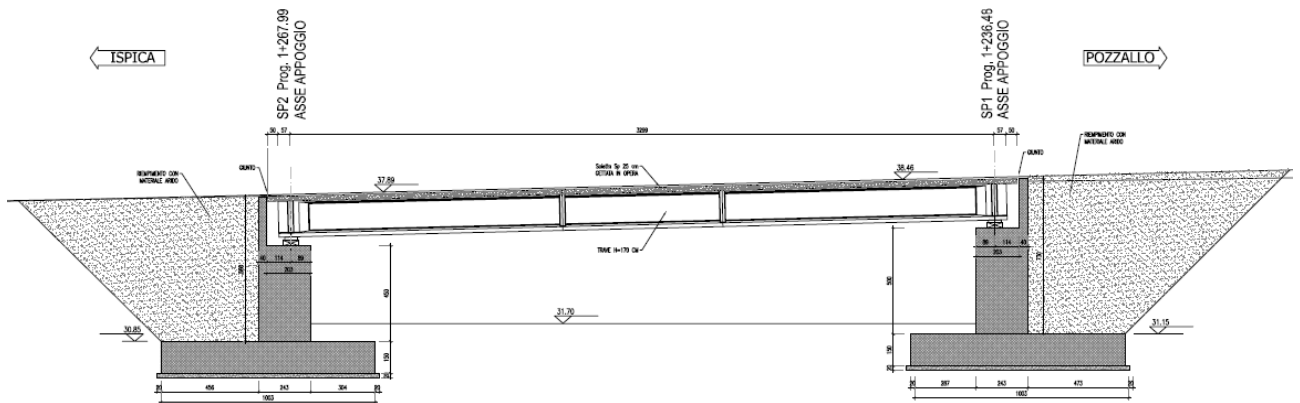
Ponte Salvia -Sezione Longitudinale
